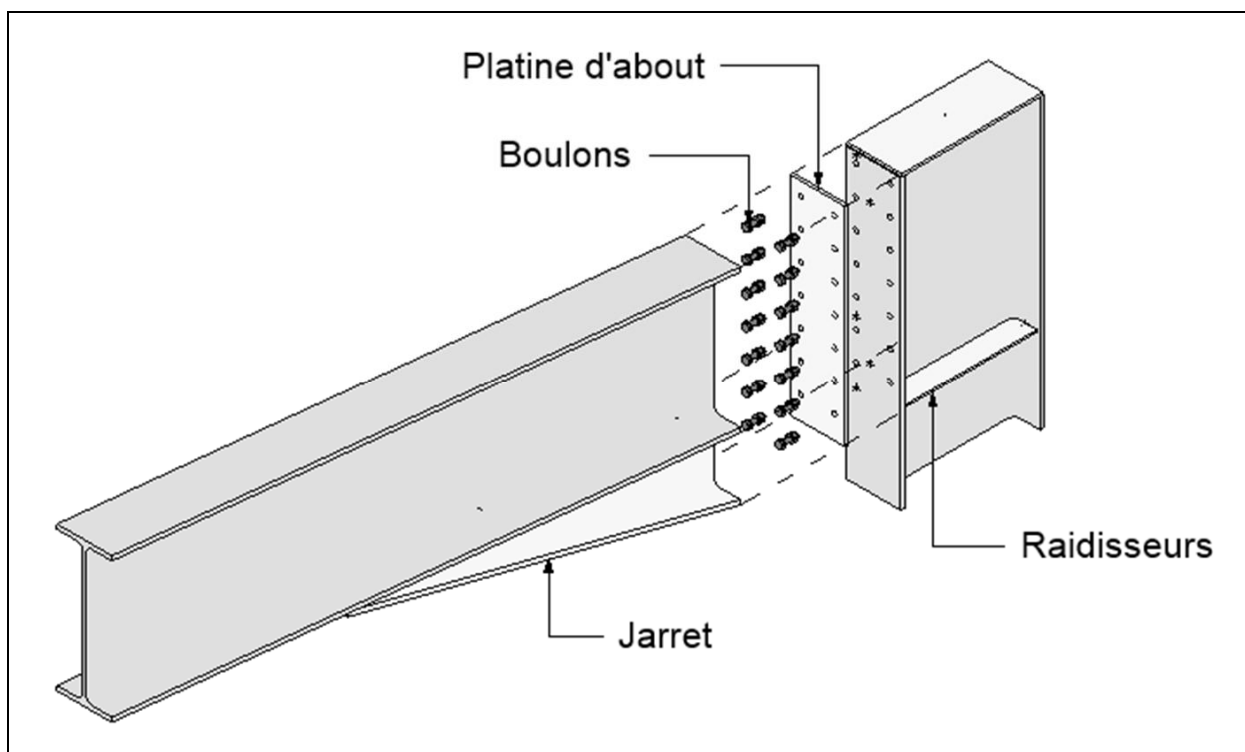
Schéma en 3D de l'assemblage poteau-traverse.
